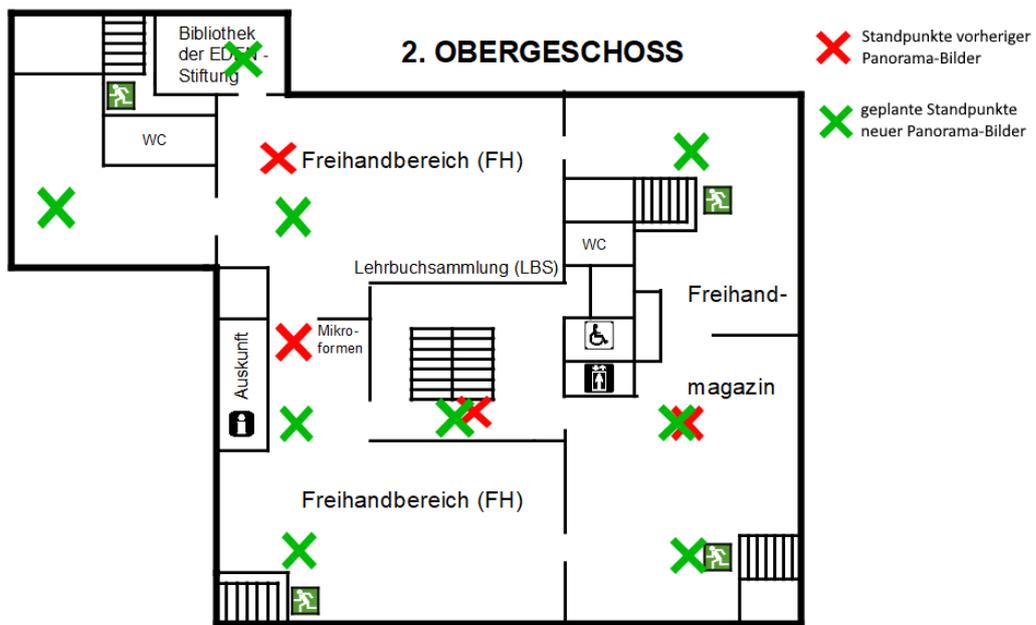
Grundriss 2. Obergeschoss UB Gießen
